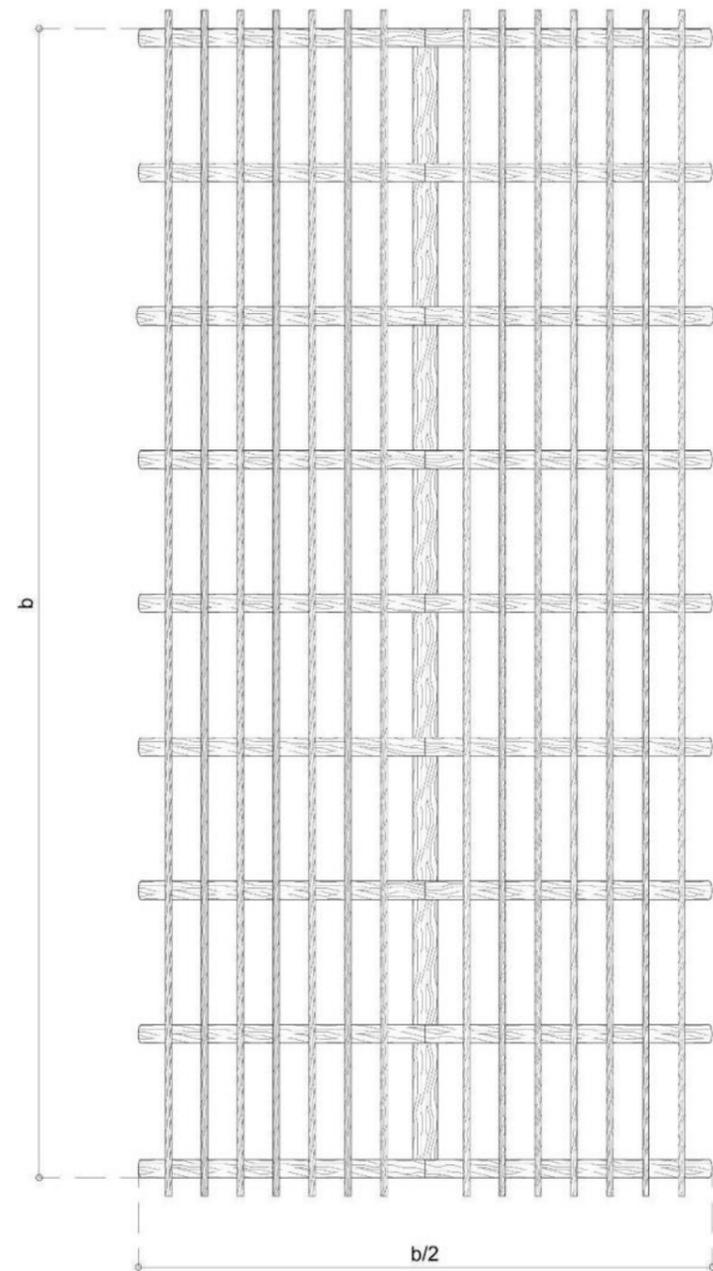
Casone secondario. Pianta dell'orditura strutturale.
